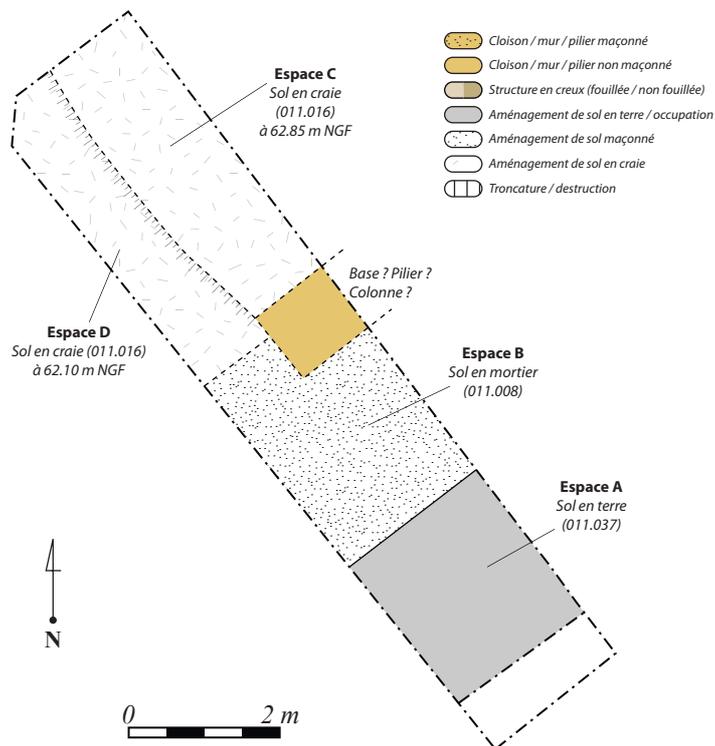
Plan de l'espace aménagé après le chantier de construction
